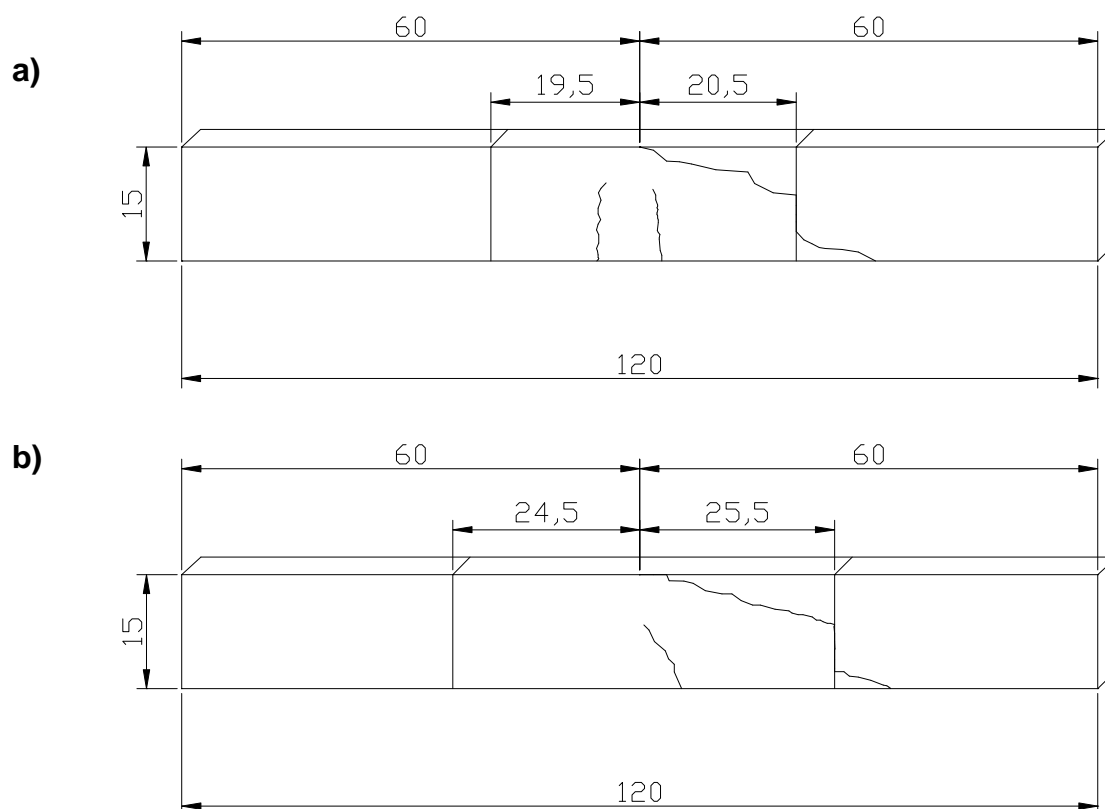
Esquema de fisuración de vigas después de la aplicación de carga mecánica. Medidas en cm. a) viga 6 b) viga 9
